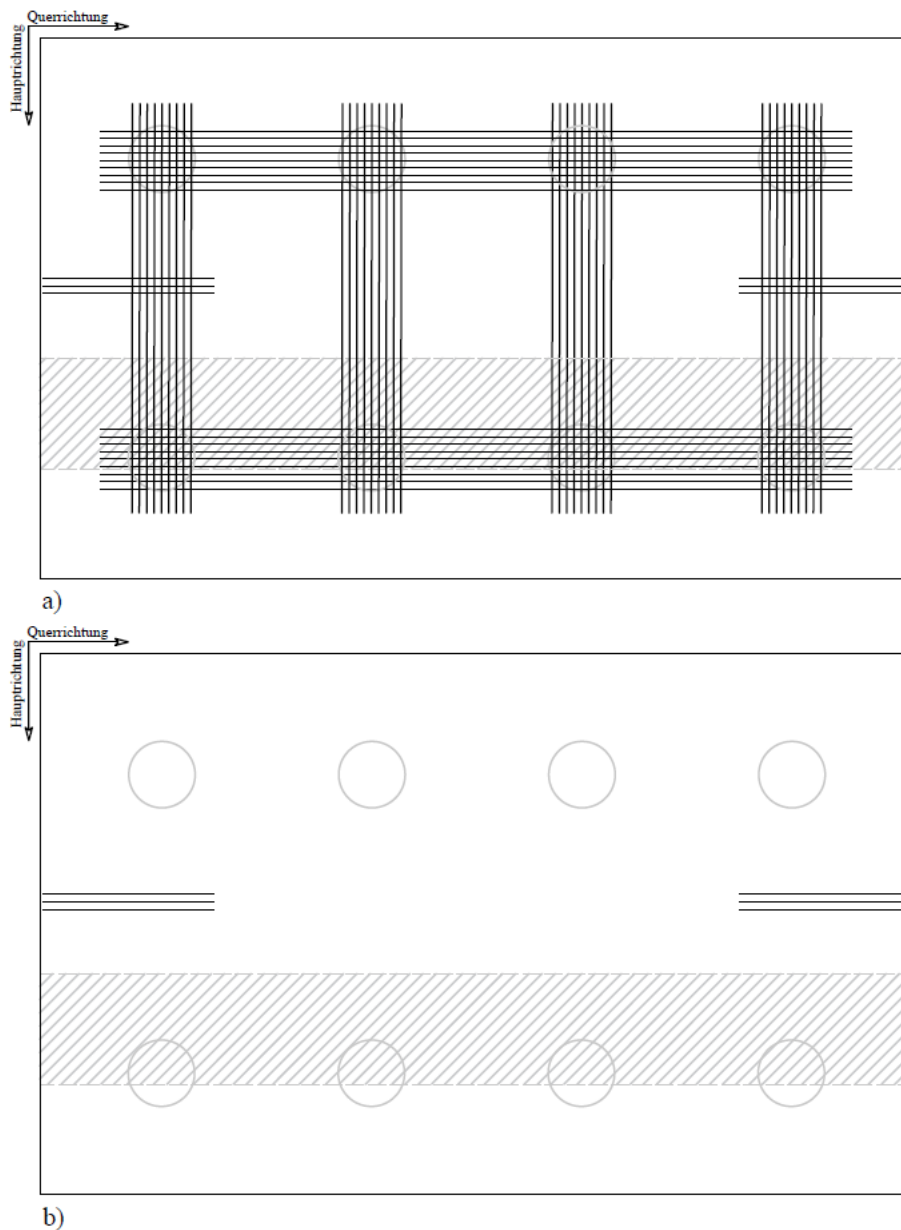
Variante 1 Lastfall 1 - a)Bewehrung unten, b)Bewehrung oben
